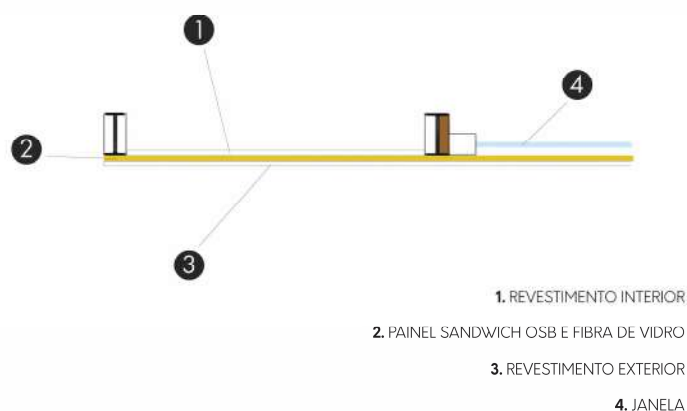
Vista em corte que demonstra a posição das paredes exteriores.
